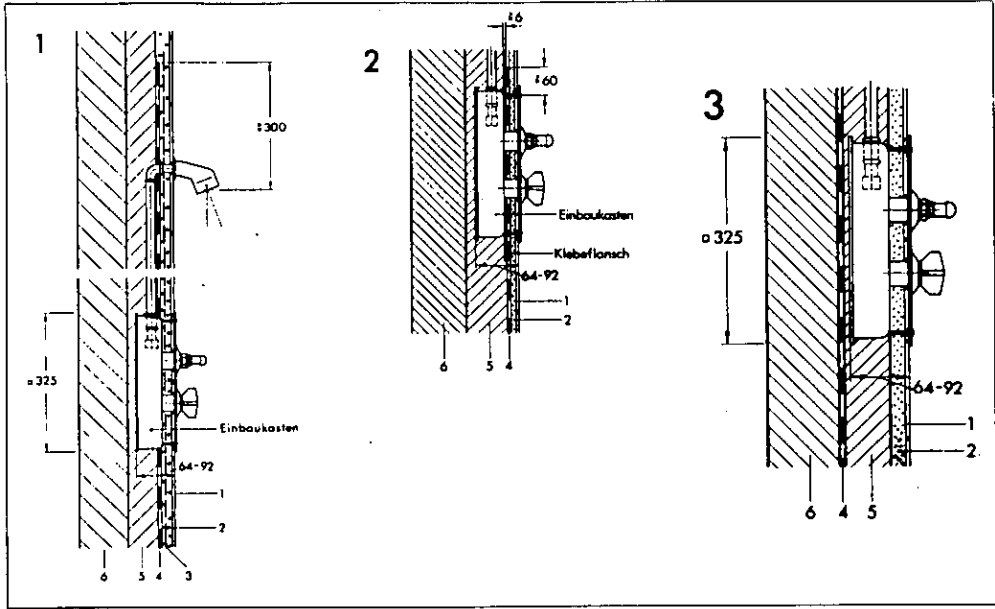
Abdichtungsausführungen bei einer Brausearmatur mit Einbaukasten innerhalb einer Wand mit Vormauerung [6]
